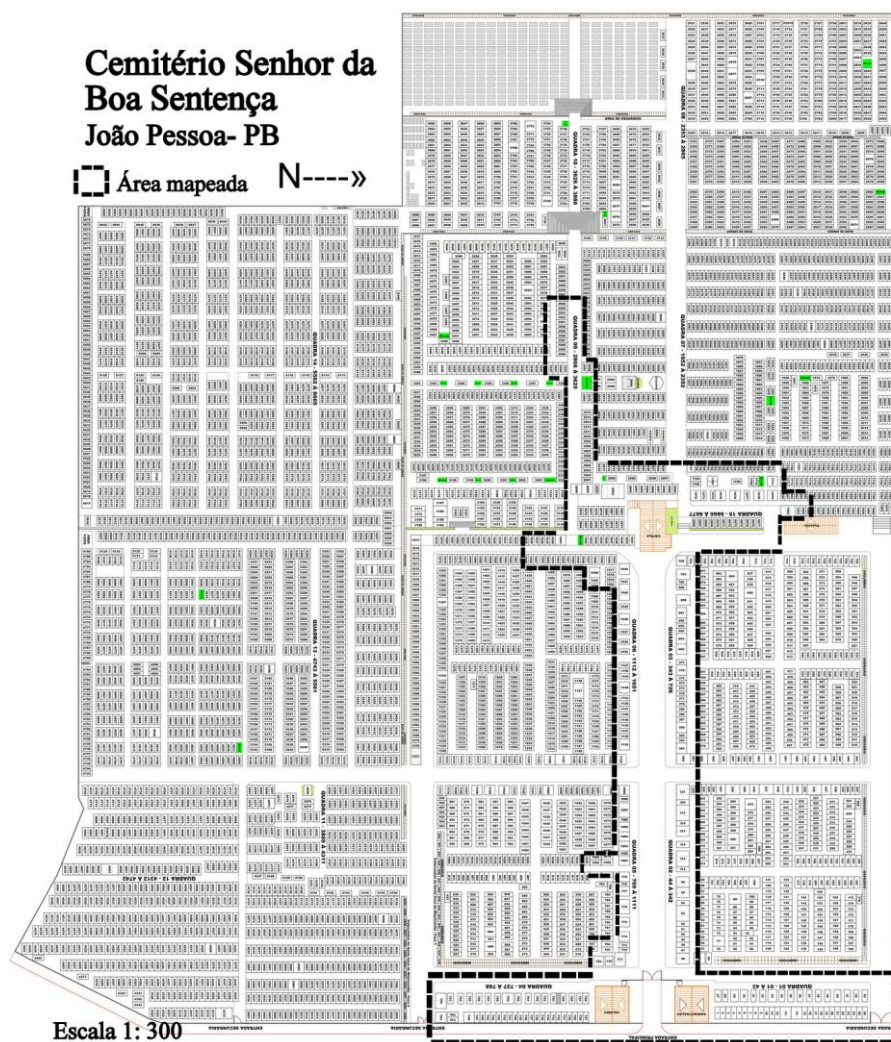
Planta do cemitério, com a disposição dos túmulos e a delimitação da área mapeada.
